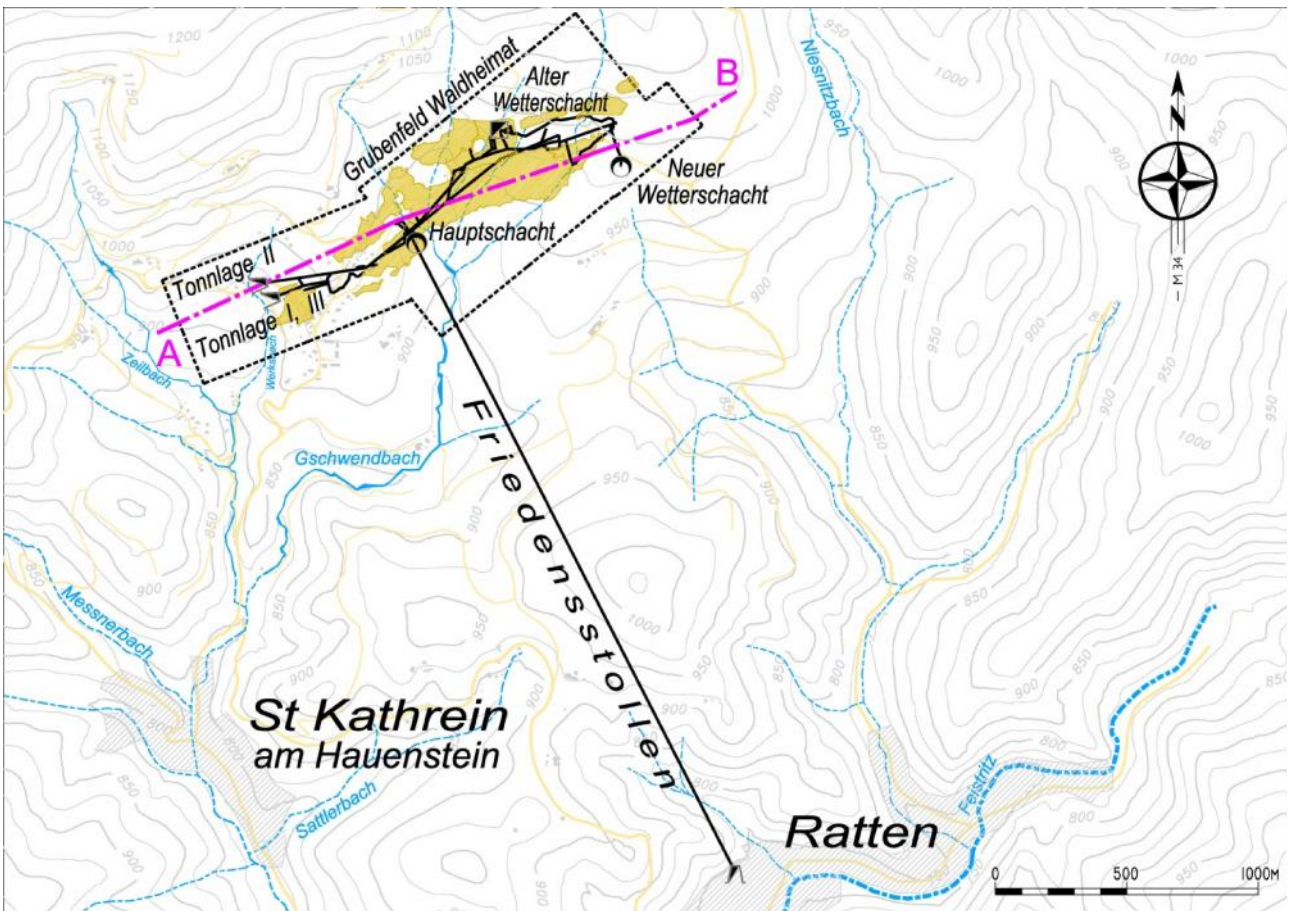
Überblick Bergbau Ratten/St. Kathrein, Grundriss
